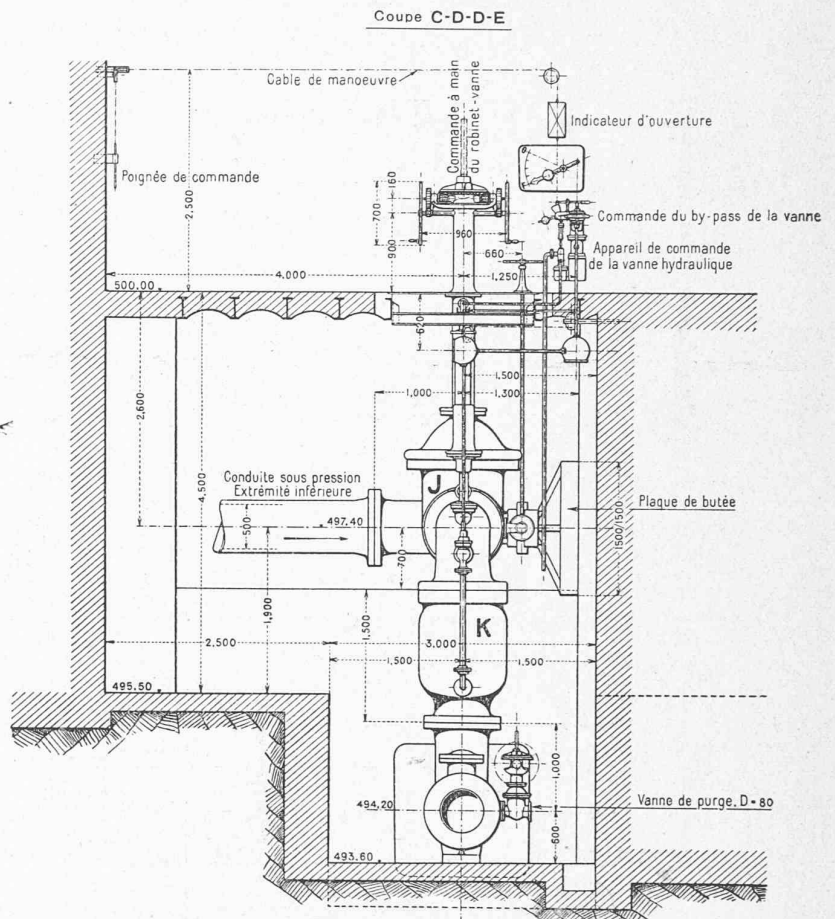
Plan d'installation des vannes à l'entrée du collecteur.
